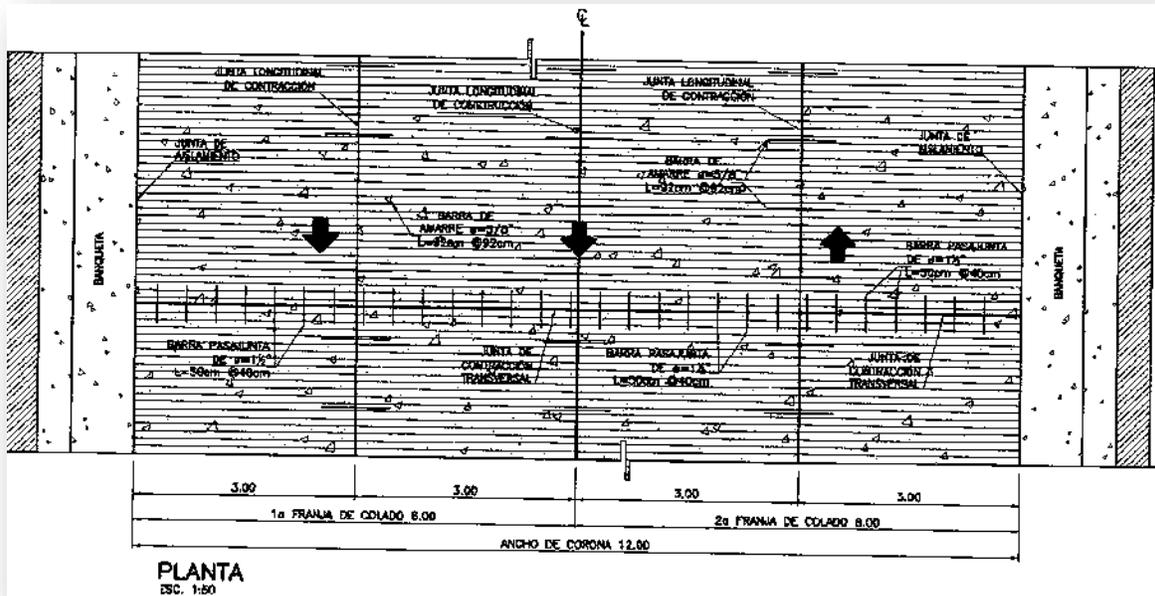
Planta de juntas constructivas, pasajunta y barras de amarres (Proyecto ejecutivo).
